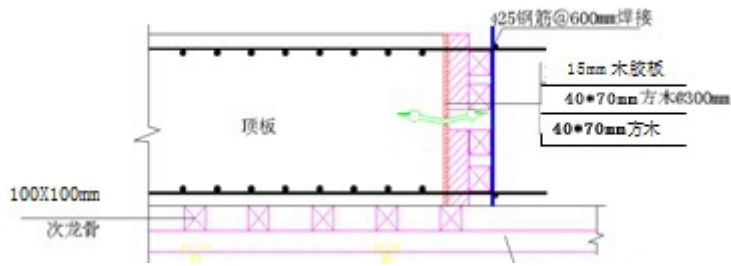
顶板施工缝端头模板及支撑体系剖面图
